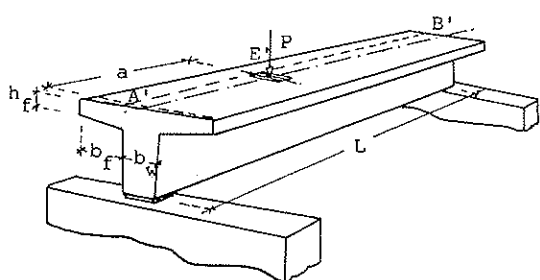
Viga de sección en T, sometida a la acción de una carga P concentrada en una estrecha faja.
